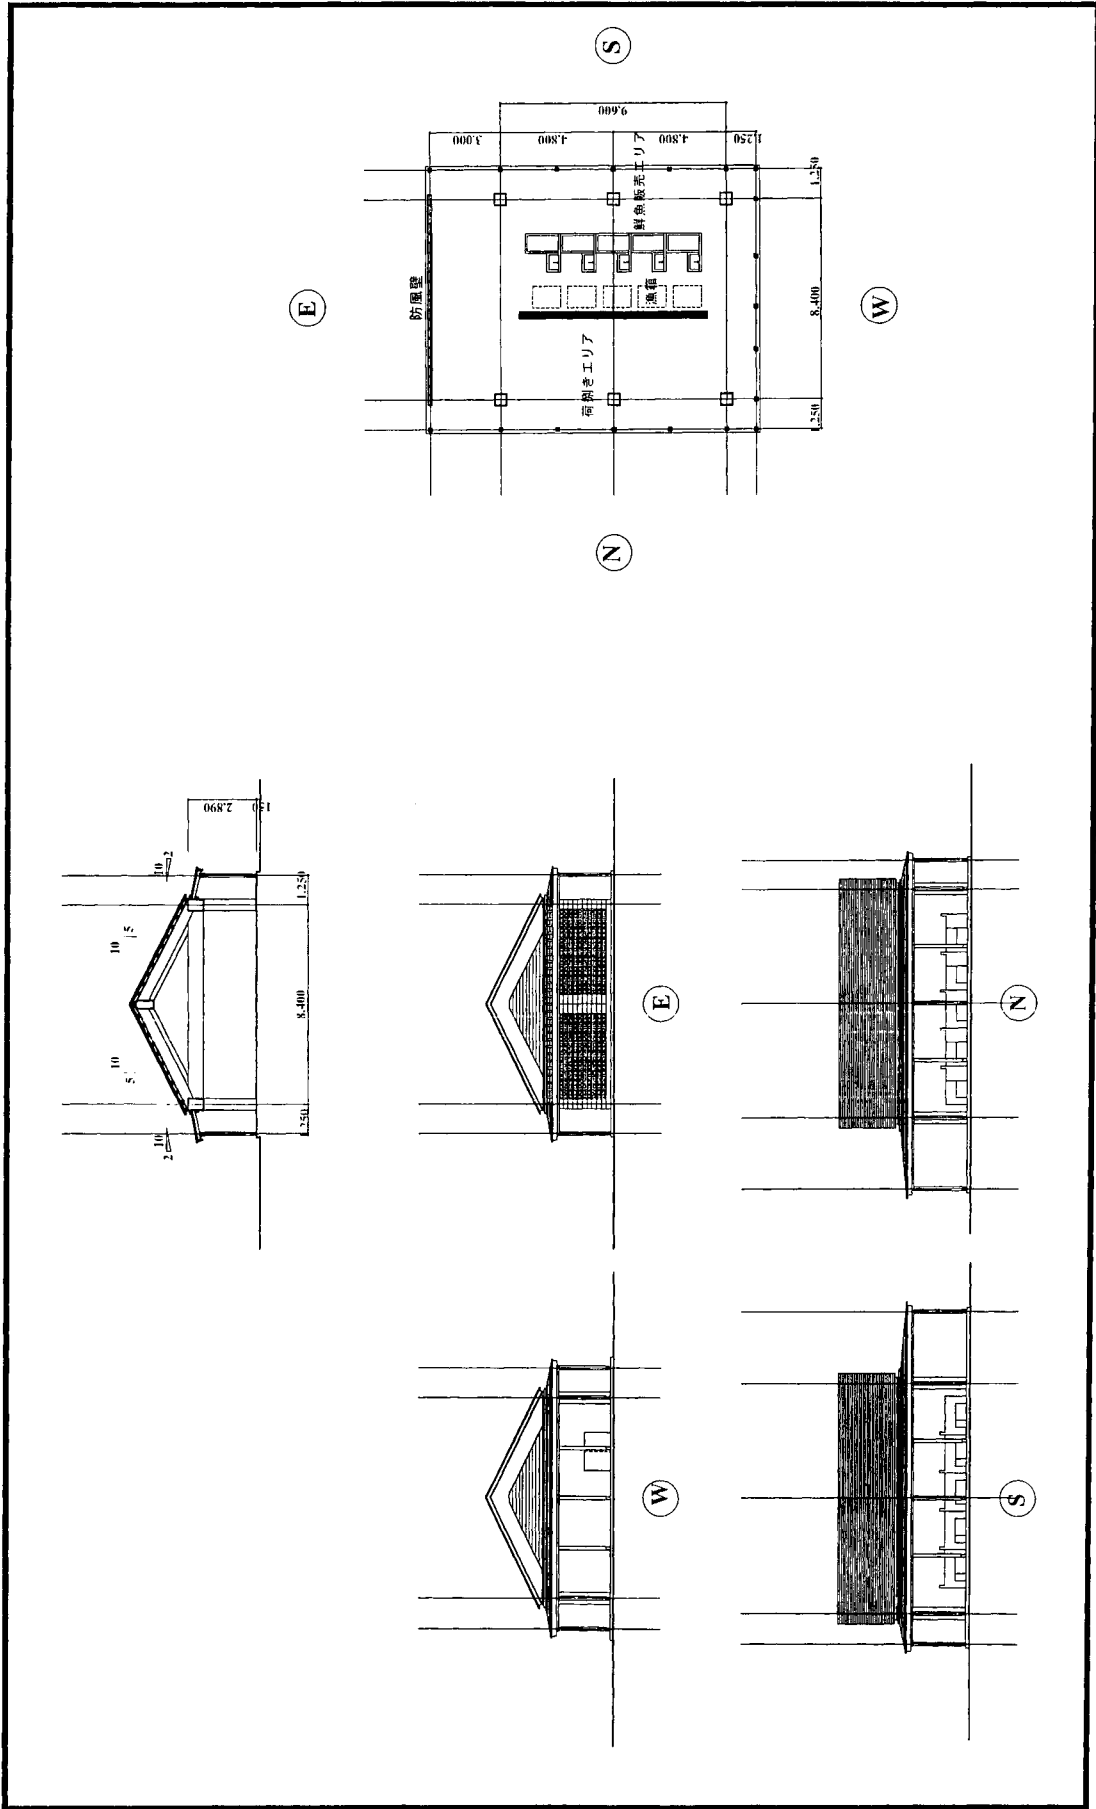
荷捌所・魚小売場平面・立面図
